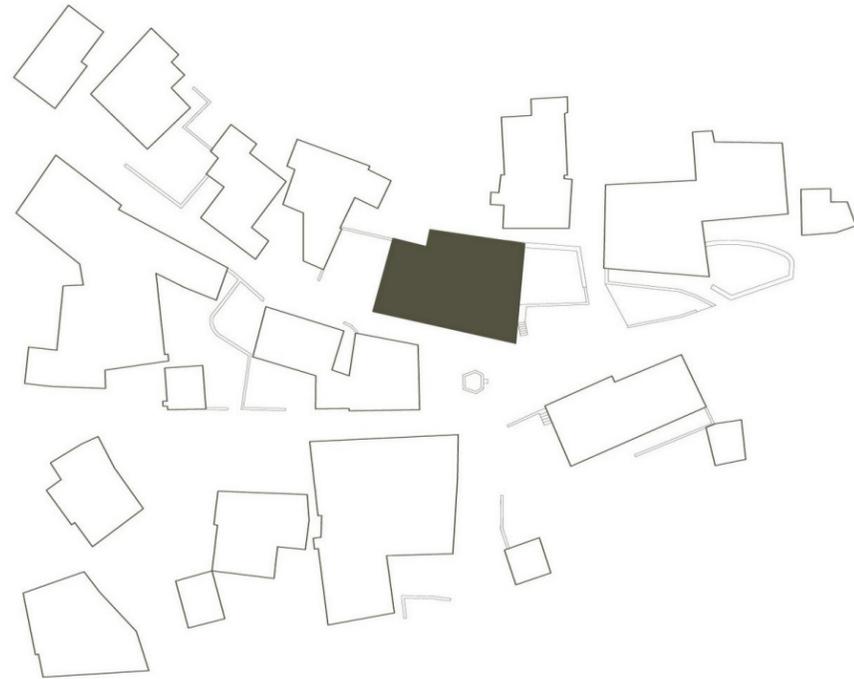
Plan d'implantation de l'Atelier Bardill
